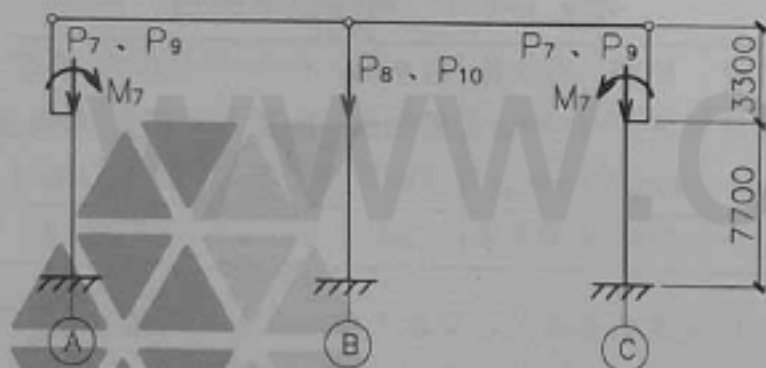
吊车梁及吊车轨道联结自重荷载简图
